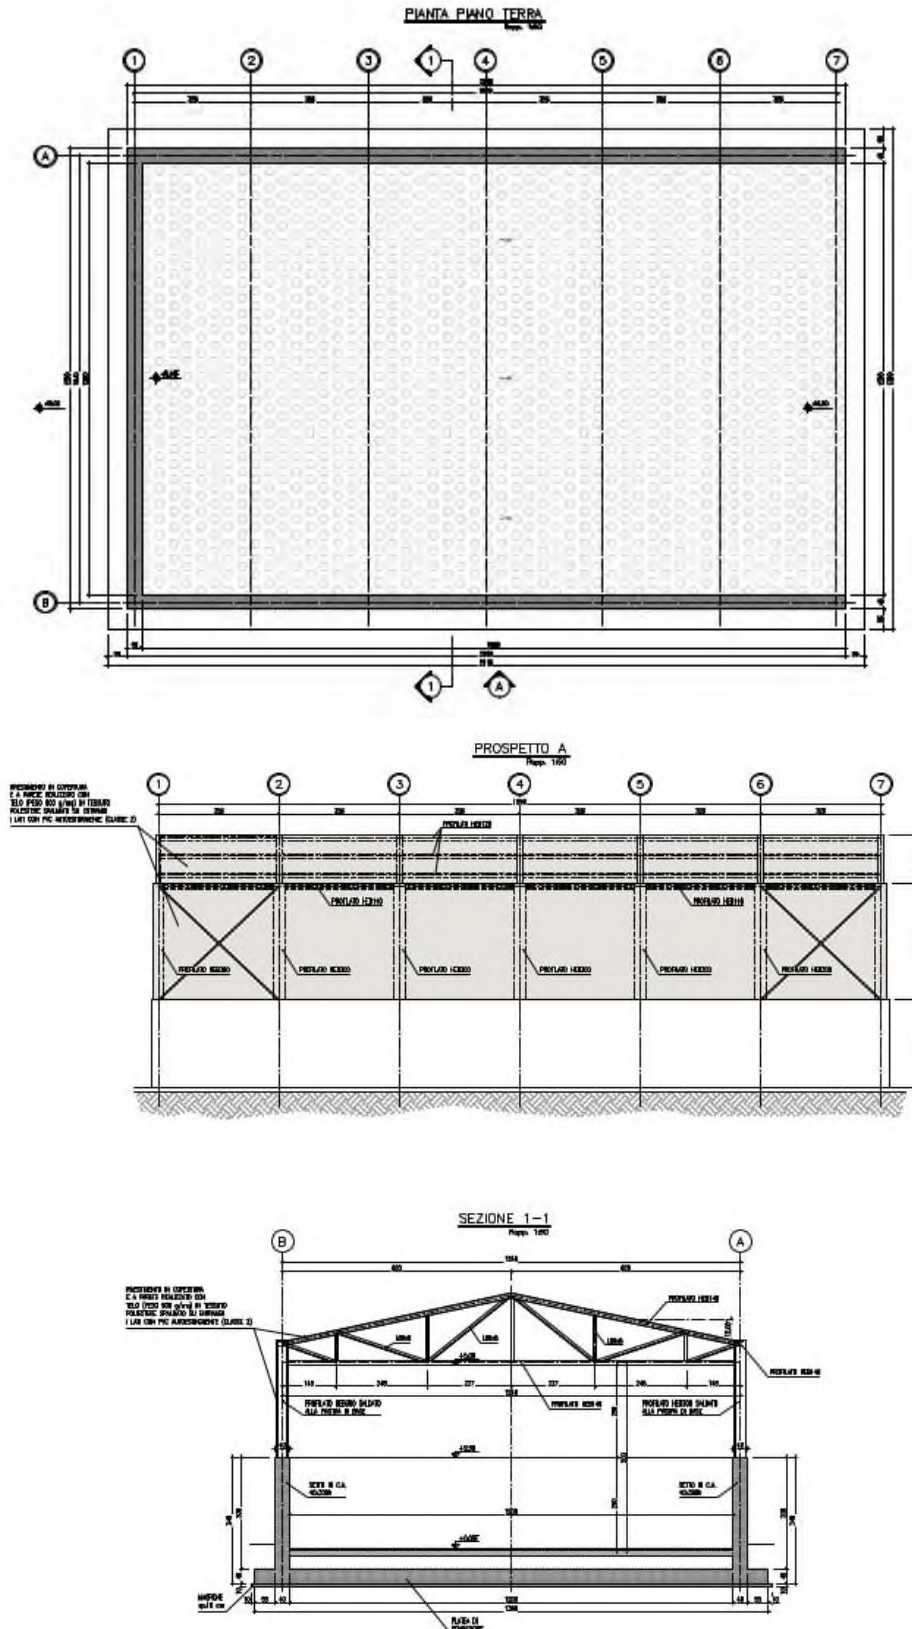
Deposito sale – Pianta, prospetto e sezione
